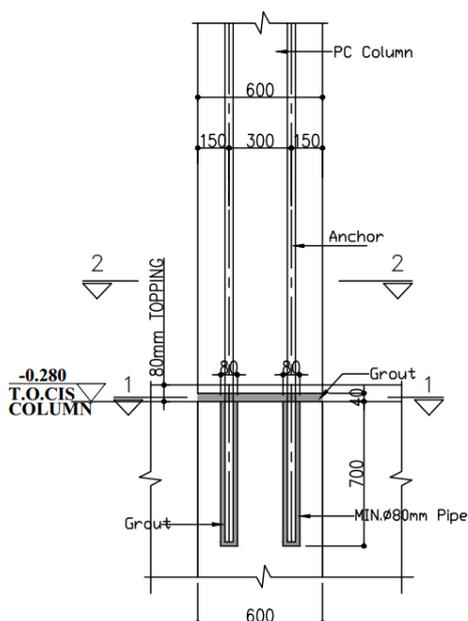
Detalle de arranque/continuidad de pilares prefabricados
